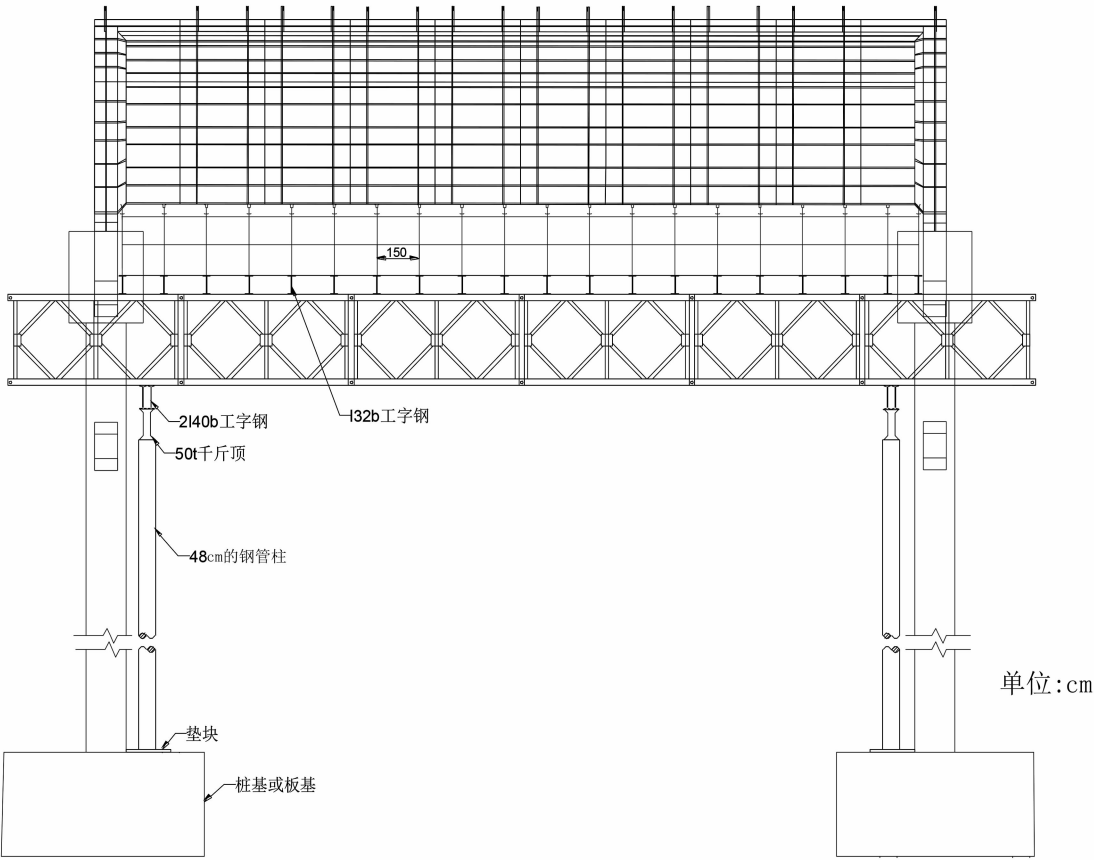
钢管柱+贝雷架施工支架纵剖面示意图
